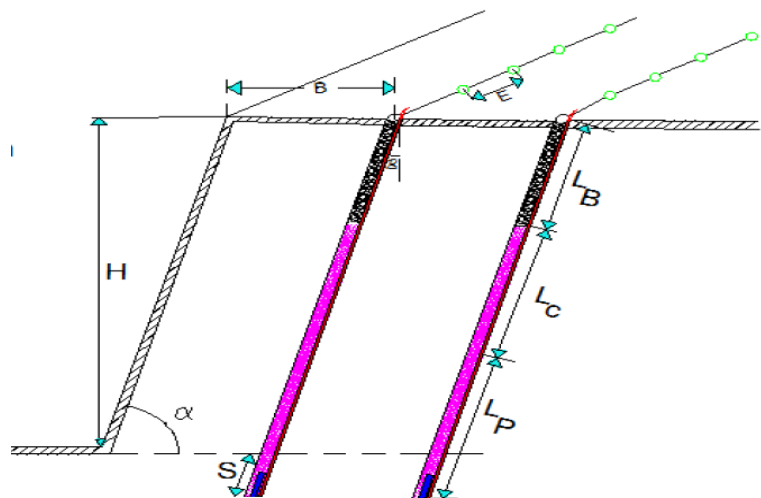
Paramètres de chargement dans un plan de tir. [8]
